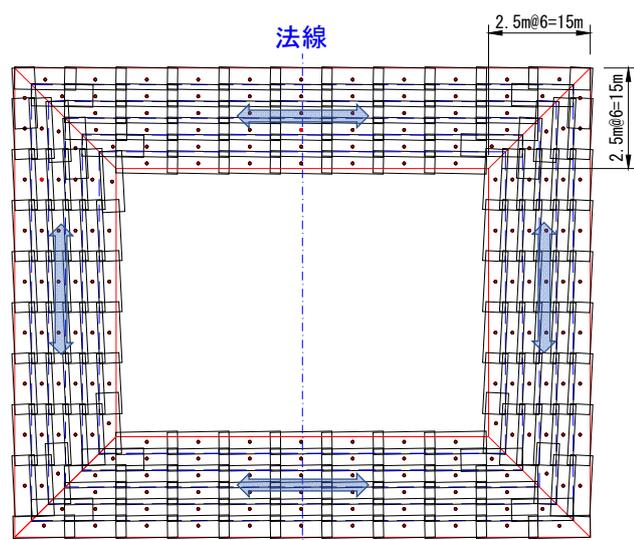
法面部掘進（法面平行方向）イメージ平面図
